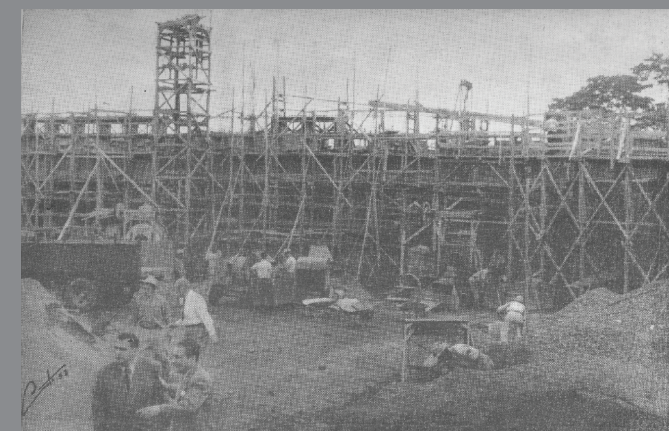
Vista de la Facultad de Ingeniería en construcción, 1953. En primer plano se ve a Rodrigo Facio y a otros.
